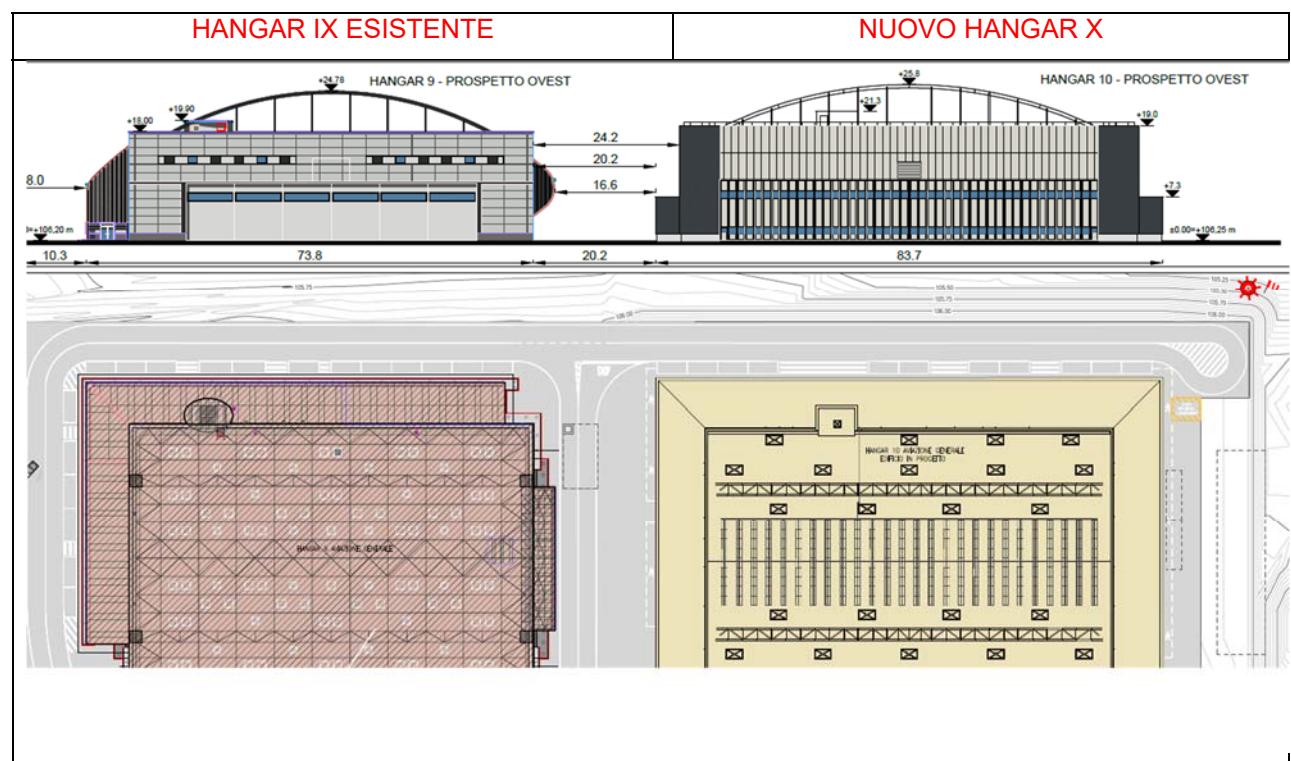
Sezione e pianta di progetto del nuovo hangar X (quota imposta 106.25 m s.l.m.) e dell'hangar IX esistente
